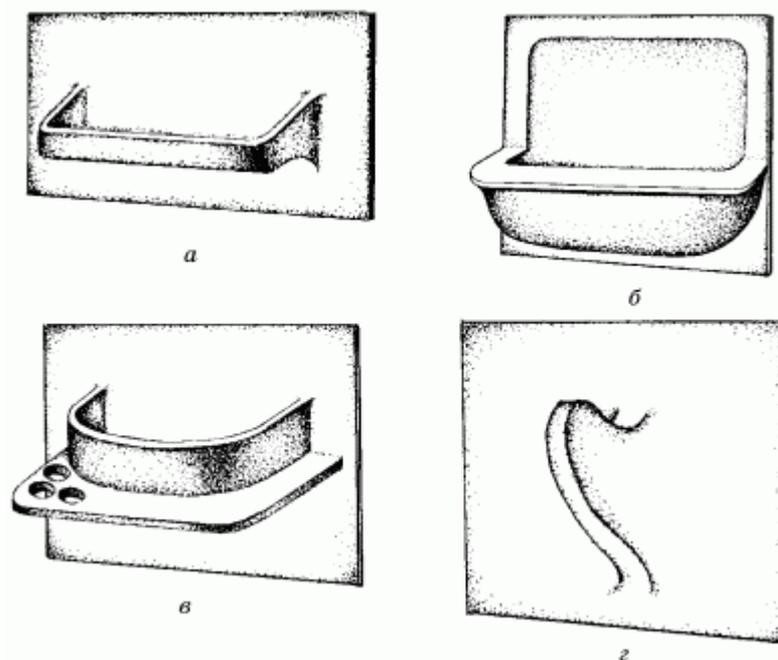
Плитка со встроенными деталями: а) полочка; б) мыльница; в) подстаканник для зубных щеток; г) крючок.
